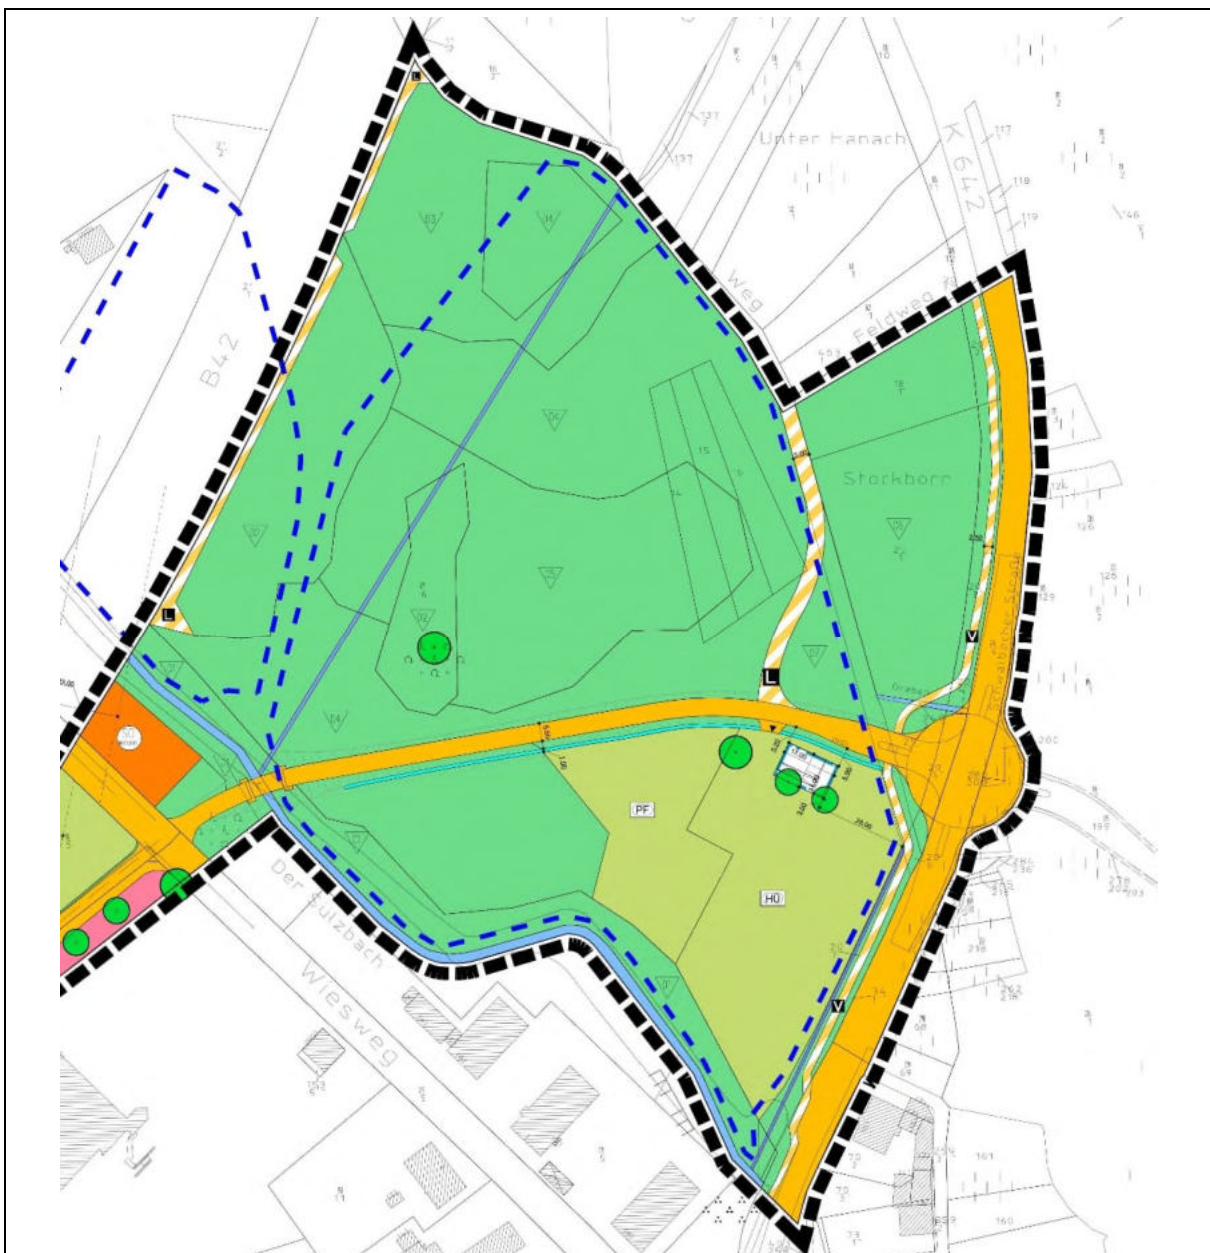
Ausschnitt Bebauungsplan „Sülzbachspange / Erschließung Obersetzling“, Planergruppe ASL, 2006, o.M.
